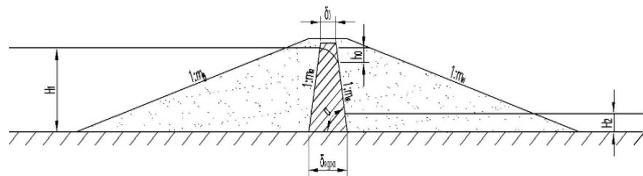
Схема неоднородной плотины с грунтовым ядром на водонепроницаемом основании
